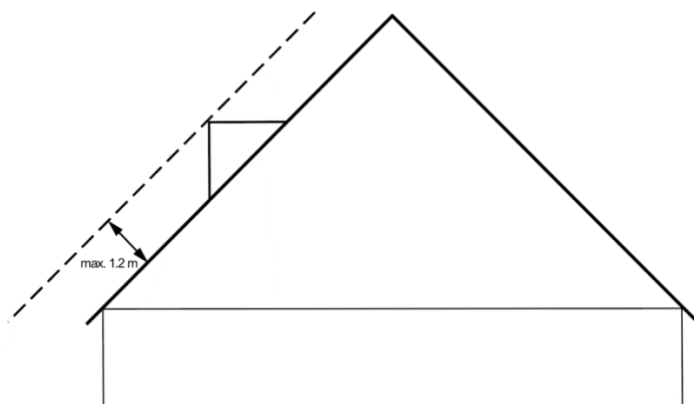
Art. 63 Abs. 4 Schrägdachbauten
